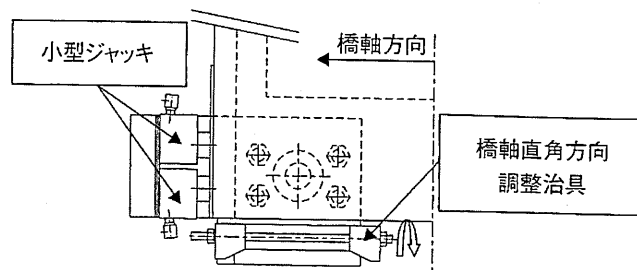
ひずみ調整治具配置図（平面図） （転載）
